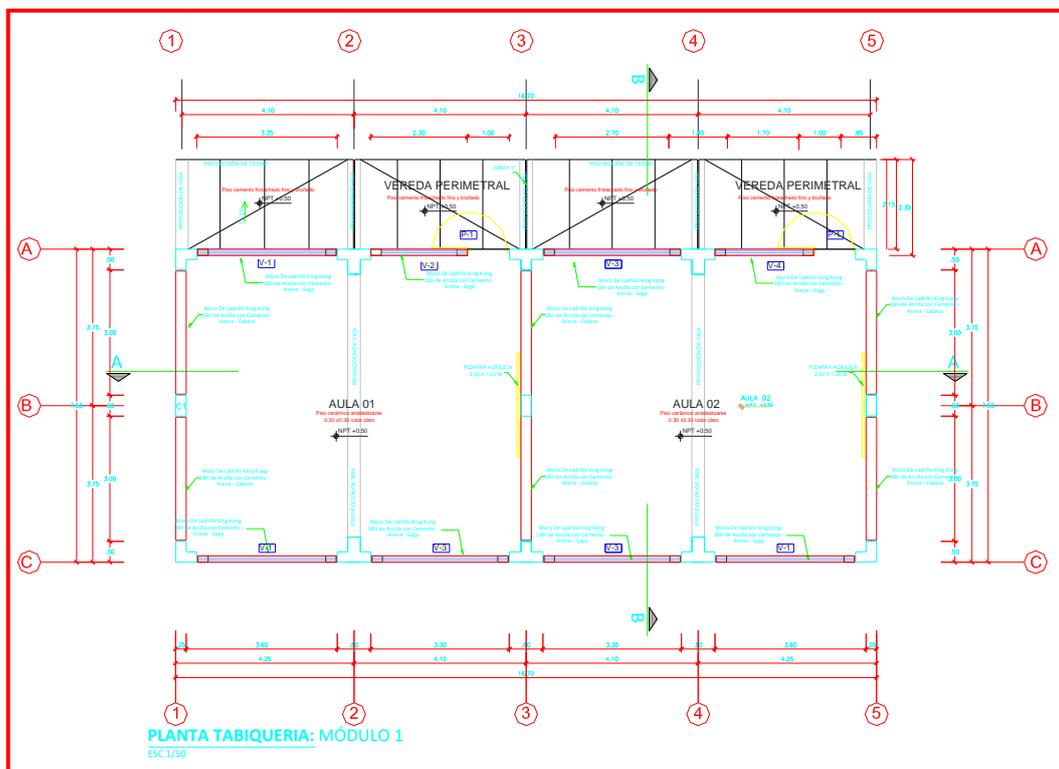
Plano de arquitectura DC-01 de la I.E. N° 586, El Dorado
